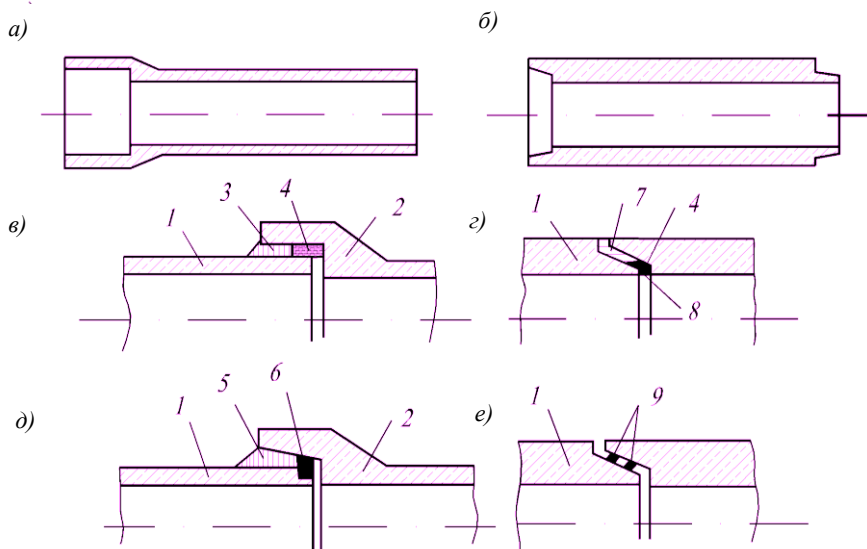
Бетонные и железобетонные трубы и способы их соединения: а – общий вид раструбной трубы; б – общий вид фальцевой трубы; в – раструбный стык с асбестоцементным замком; г – раструбный стык с резиновыми кольцами; д – фальцевый стык с просмоленной пеньковой прядью; е – фальцевый стык с резиновыми кольцами; 1 – гладкий конец трубы; 2 – раструб трубы; 3 – асбестоцемент; 4 – просмоленная пеньковая прядь; 5 – цементный раствор; 6 – желобчатые резиновые кольца; 7 – цементный раствор или асфальтовая мастика; 8 – затирка цементным раствором; 9 – круглые резиновые кольца
